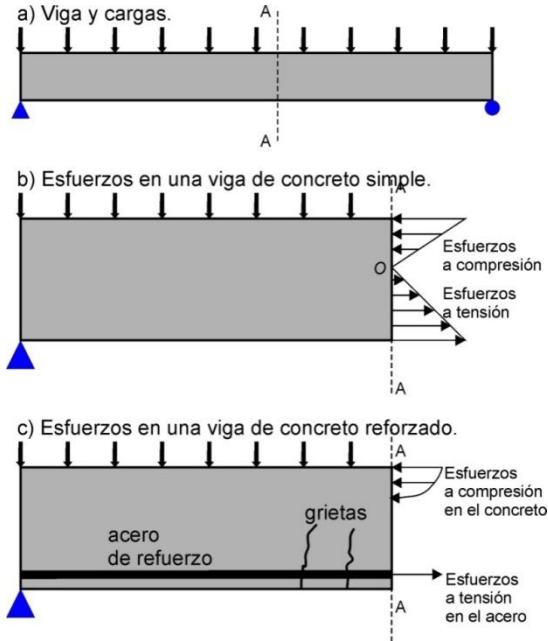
Vigas de concreto simple y concreto reforzado.
